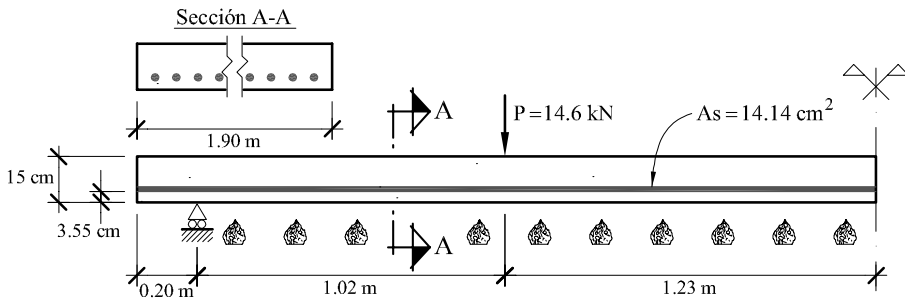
Geometría de la losa simplemente apoyada expuesta a fuego en su cara inferior.
